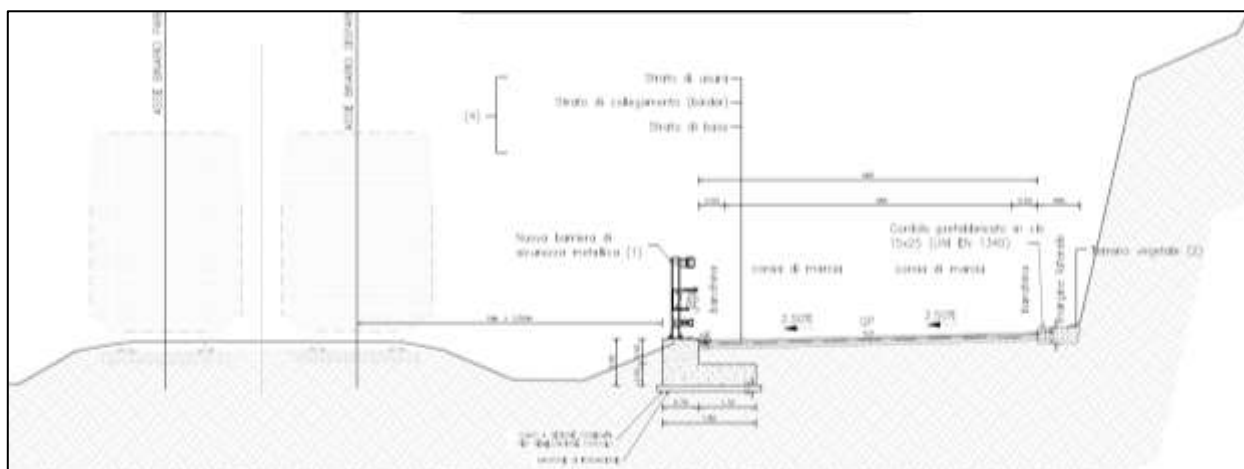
Sezione tipologica stretto affiancamento con conservazione della piattaforma stradale esistente
